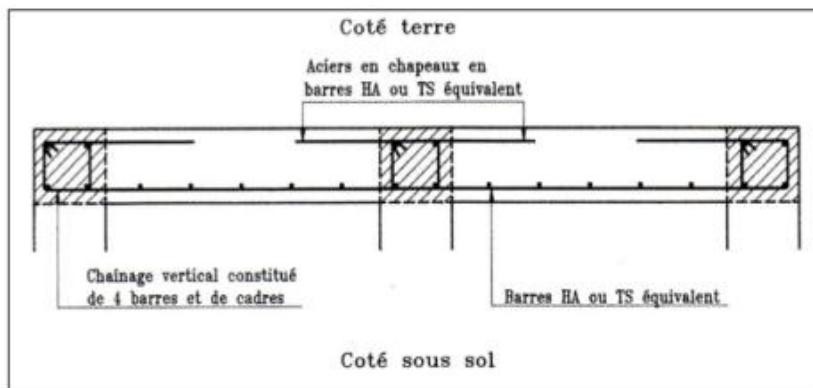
Coupe horizontale sur un mur de soutènement en béton armé
